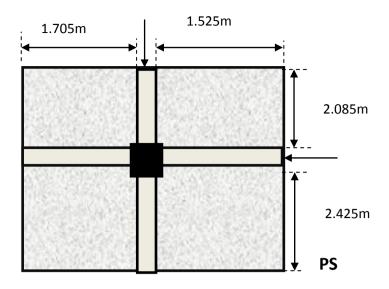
Poteau « P_2 » de la descente de charges.
